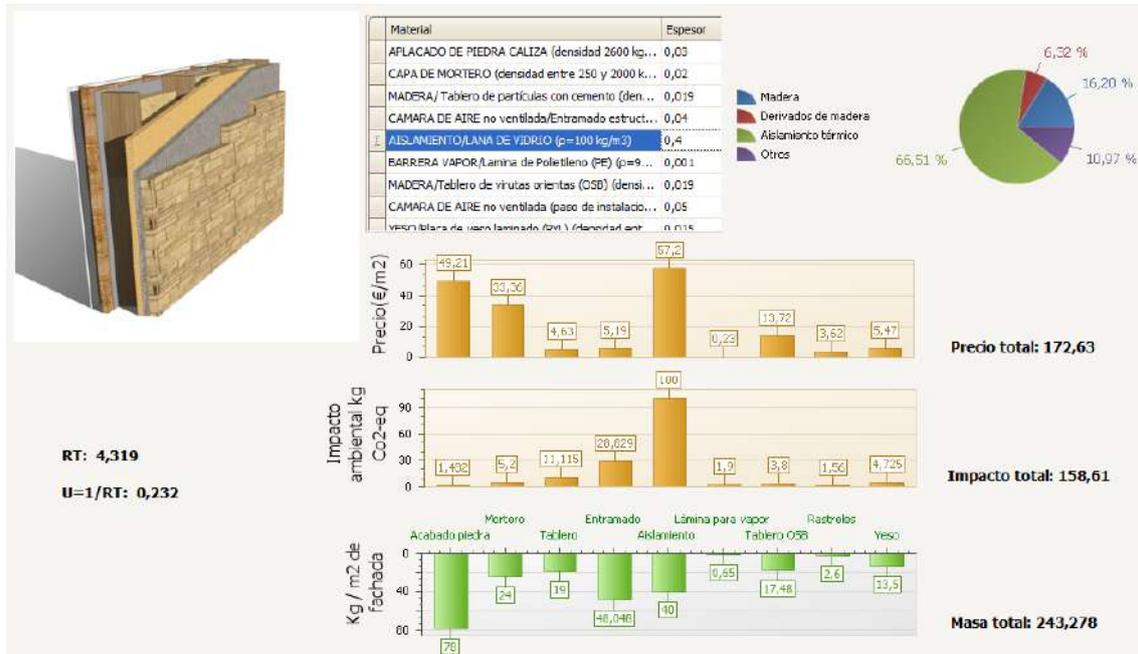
Entramado Ligero con acabado exterior de piedra
